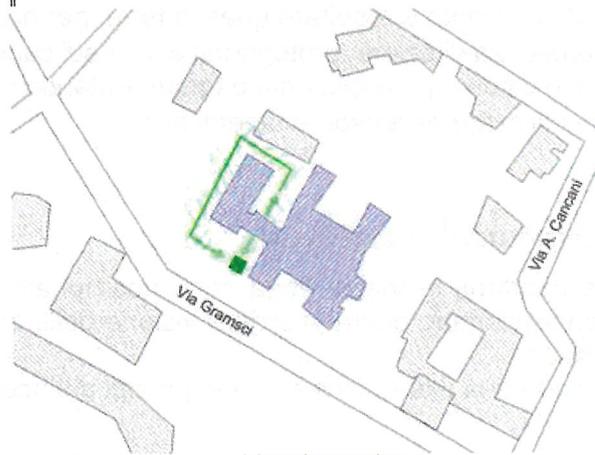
Esempio di Planimetria Generale con Punto di Raccolta
